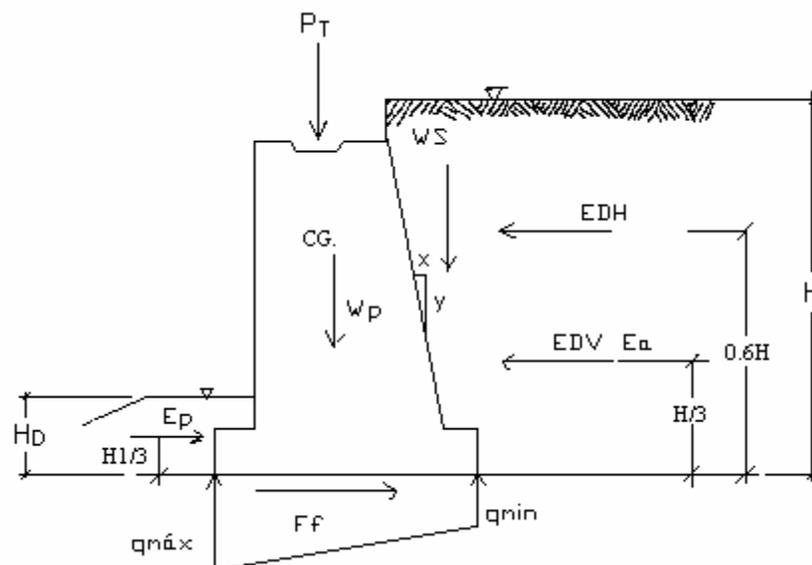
Fuerzas sobre un estribo de mampostería de piedra.
